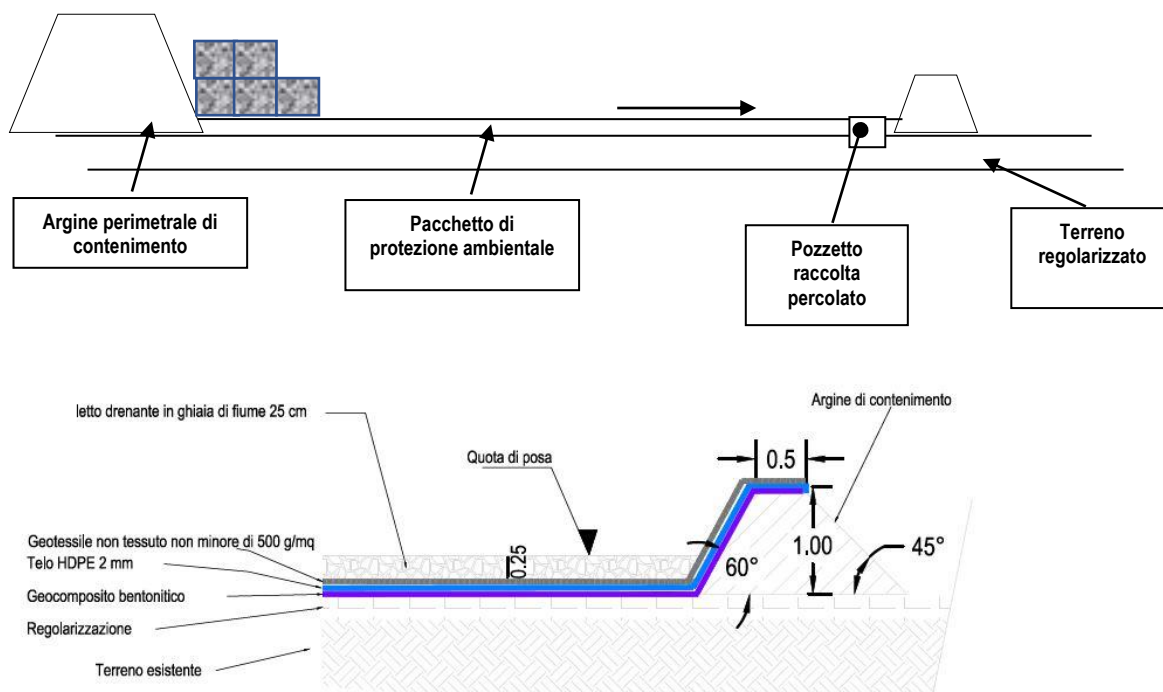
Particolare del sistema di protezione del fondo della piazzola di stoccaggio
